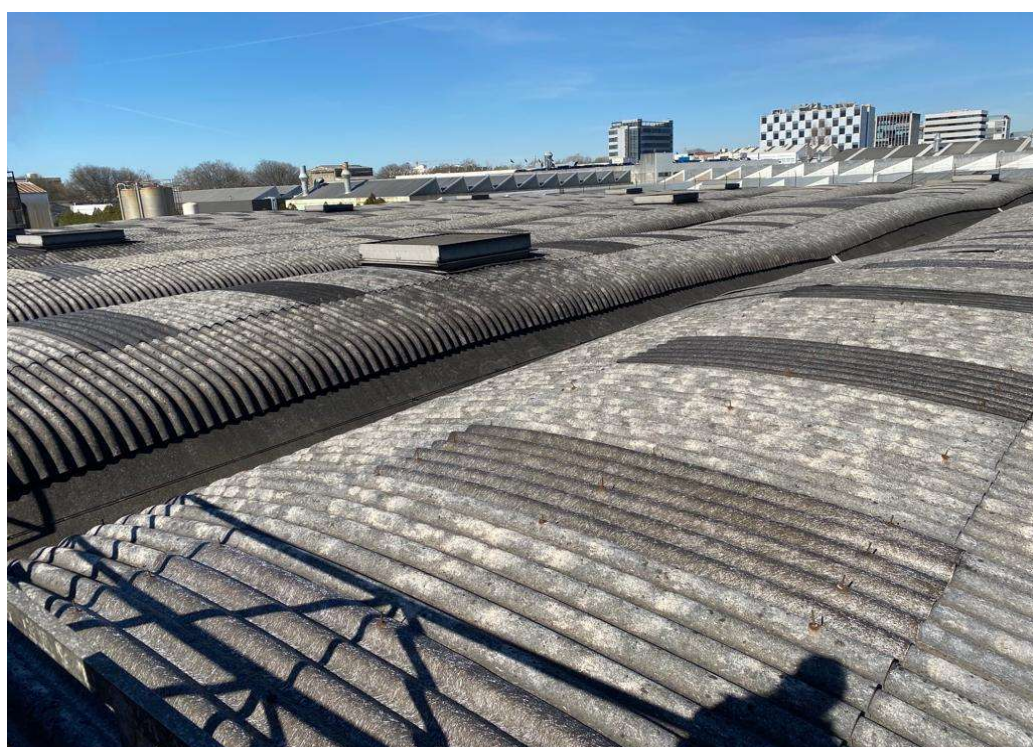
Vista superior 3 do telhado de fibrocimento
